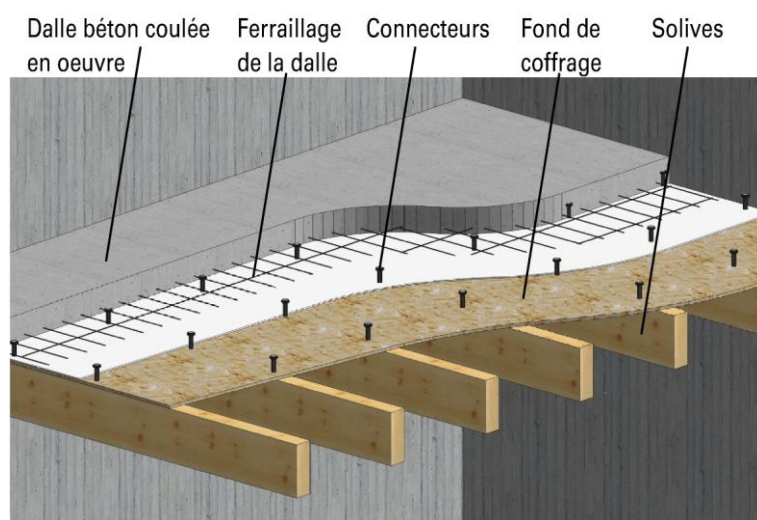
Plancher mixtes bois béton constitué de solive et platelage
